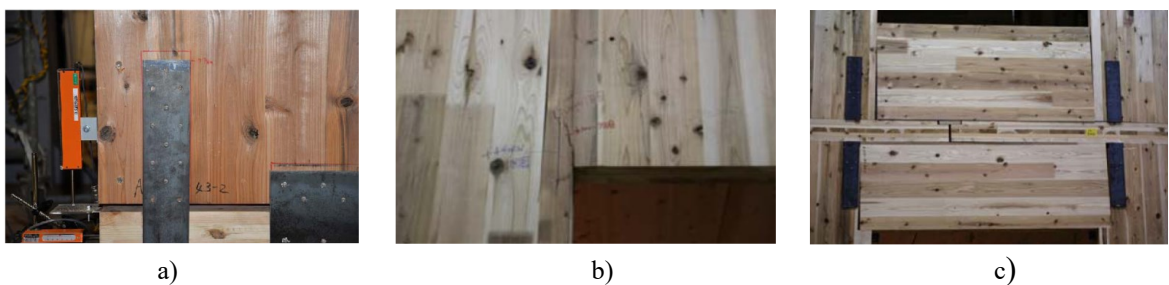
Svolgimento dei test: a) schema planimetro, b) schema in sezione longitudinale, c) esecuzione sulla struttura a pannelli monolitici (Yasumura et al., 2016).
